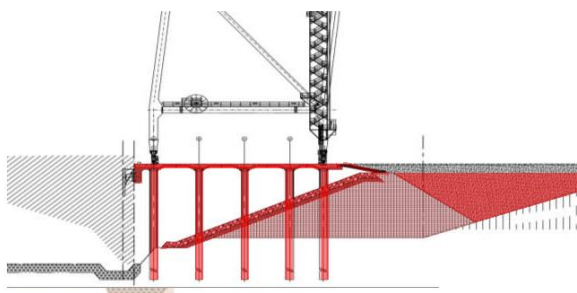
Secção transversal do terminal – Fonte: na ficha
